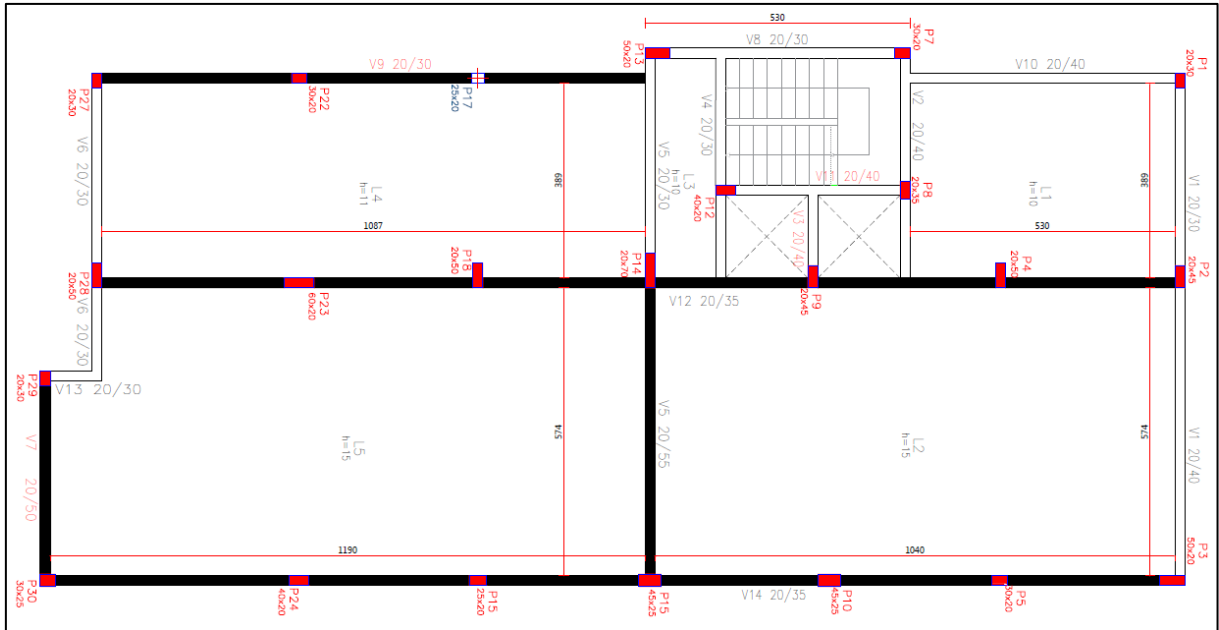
Planta de Forma Pav. Tipo – Modelo 02 – Com vento (cotas em cm)
